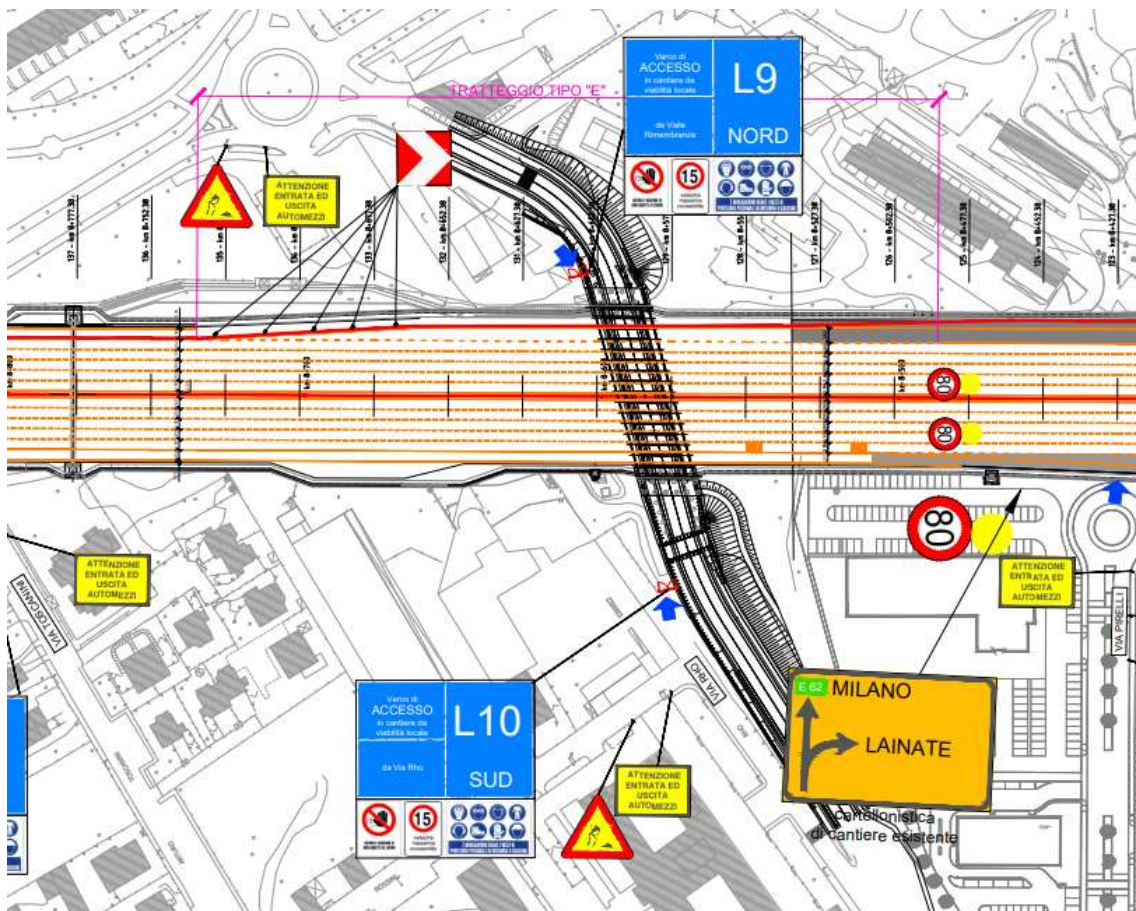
Estratto planimetria segnaletica per apertura provvisoria
